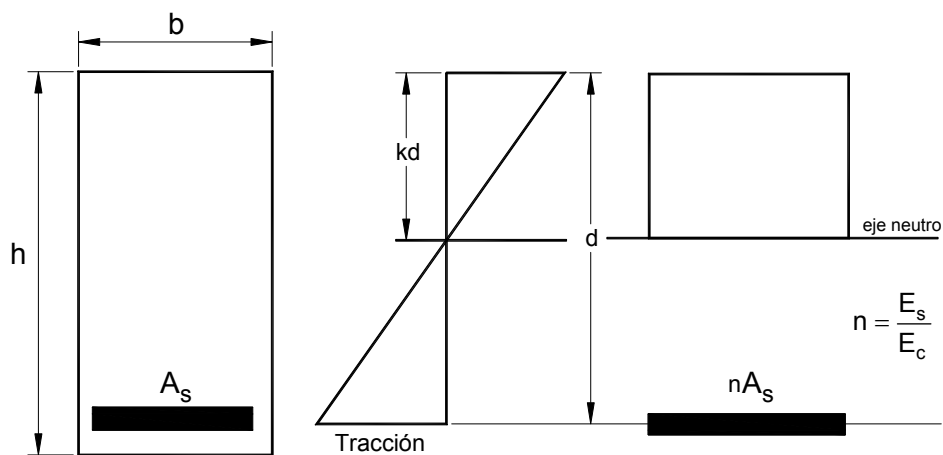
Sección fisurada transformada de una viga con armadura de tracción
